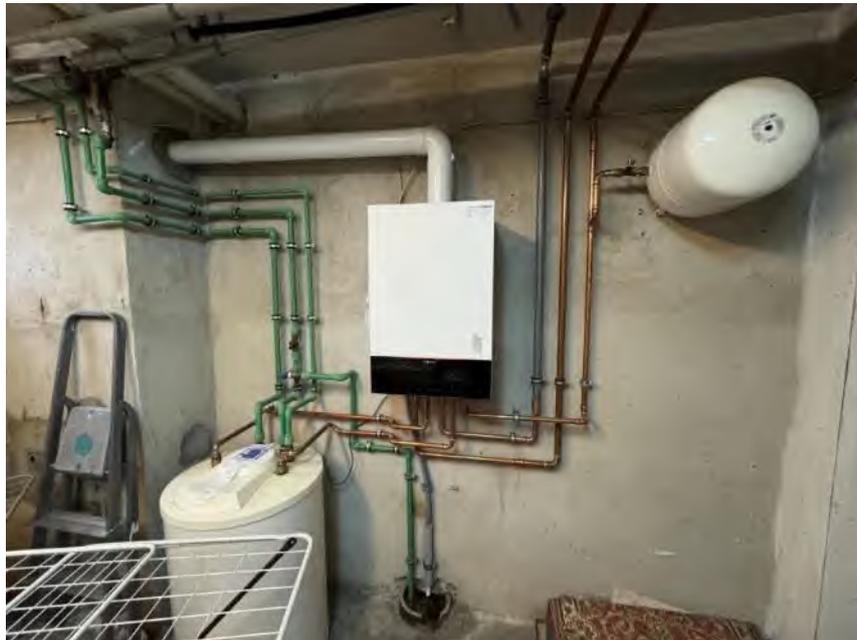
Heizungstechnik im Unter-/Kellergeschoss
